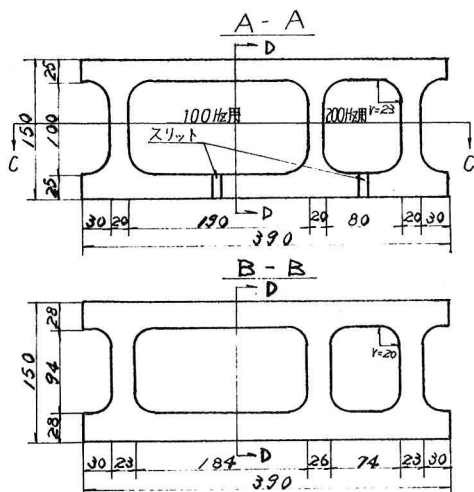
コンクリート吸音ブロック設計図 (単位:mm)
